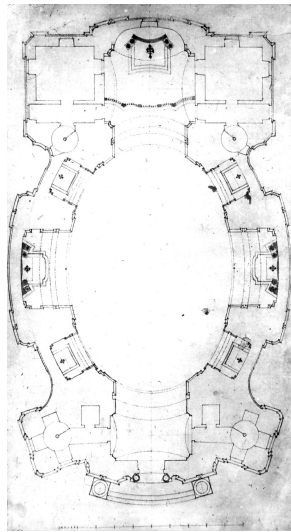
Peterskirche, Grundriss Erdgeschoß
